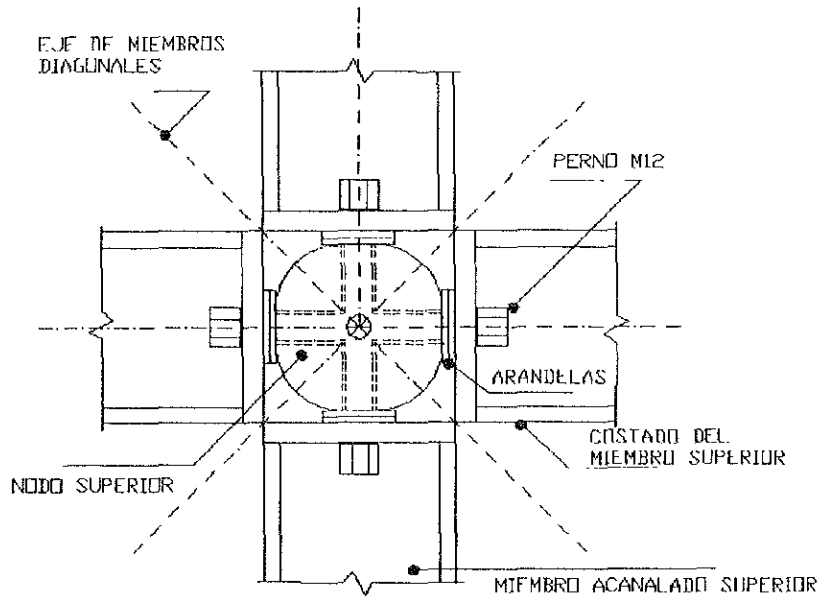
a.- VISTA EN PLANTA DE LA CONEXION DEL NODO.
